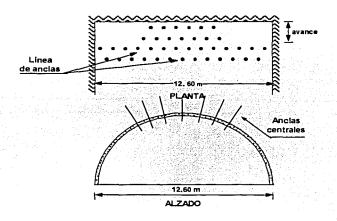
Anclaje central utilizando elementos de 1" Ø x 4.2 m.
